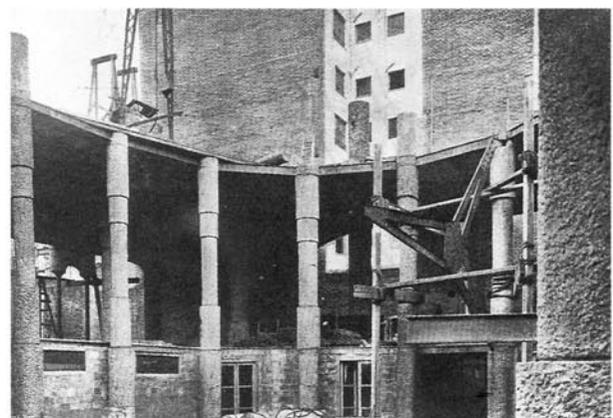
La estructura de la Pedrera en construcción. (Foto IMH. Publicada en “La edificación moderna” en marzo de 1908).
